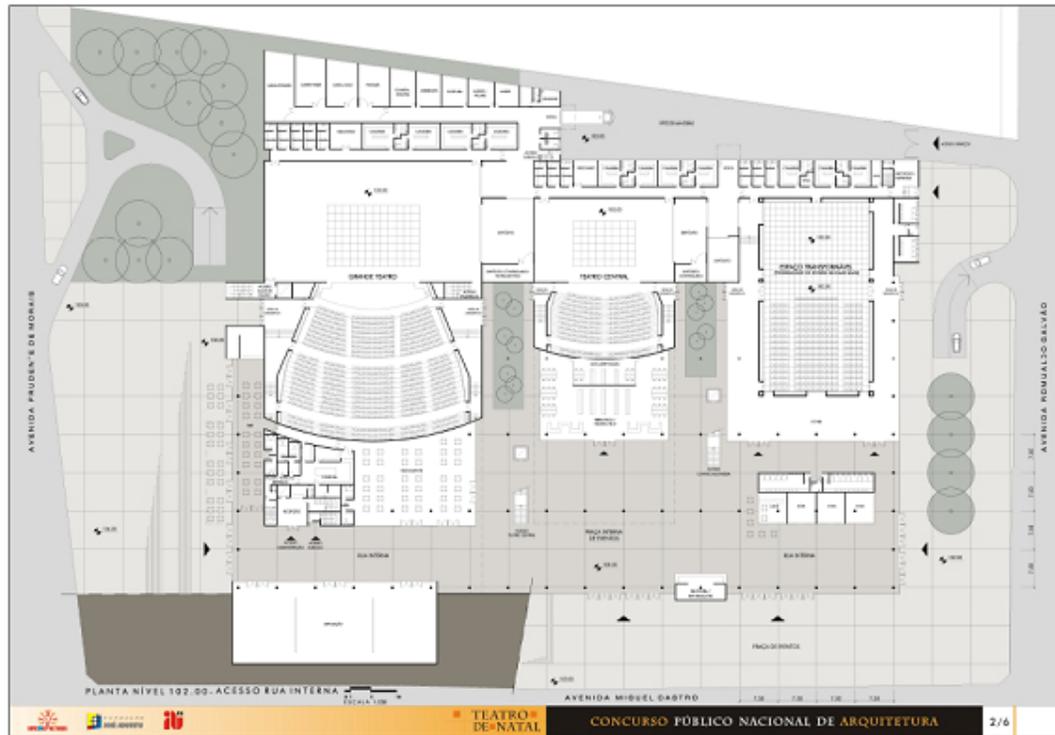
Planta baixa na prancha 02 do projeto Renato Dalpian. Fonte: FJA.
